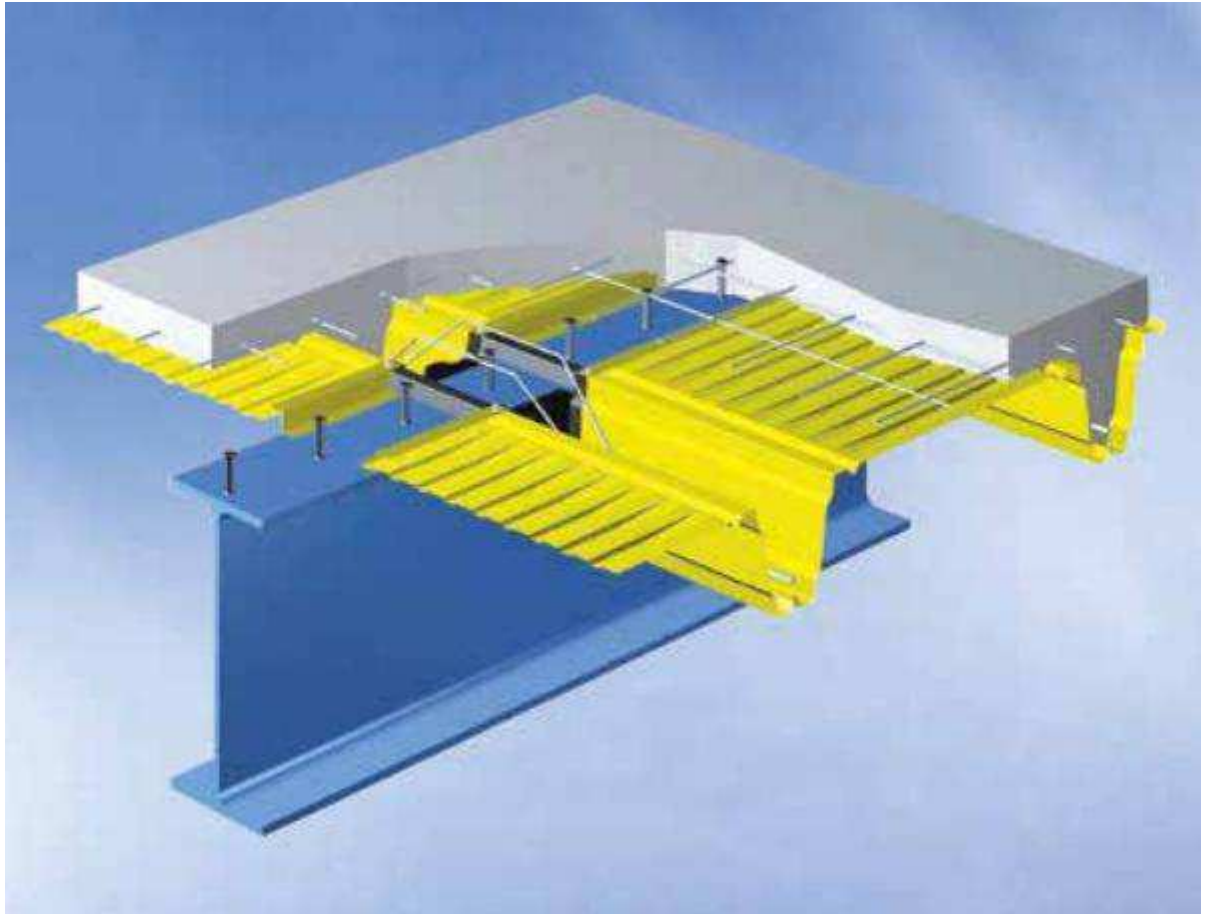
Конструкция монолитного перекрытия с применением стального профилированного настила Н80А-674-1 в качестве несъемной опалубки и внешней арматуры
